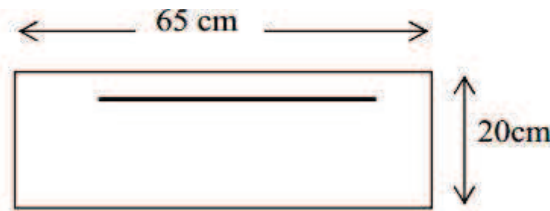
Coupe schématique de la poutrelle (travées)
